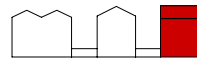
1/2-Zimmer-Wohnung 22
